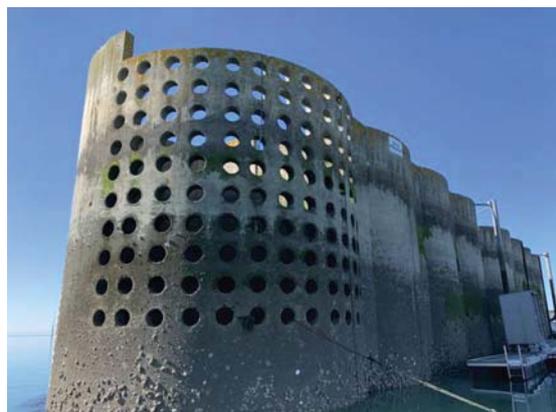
Digue secondaire de protection en caissons auto-stables alvéolaires en béton armé.
